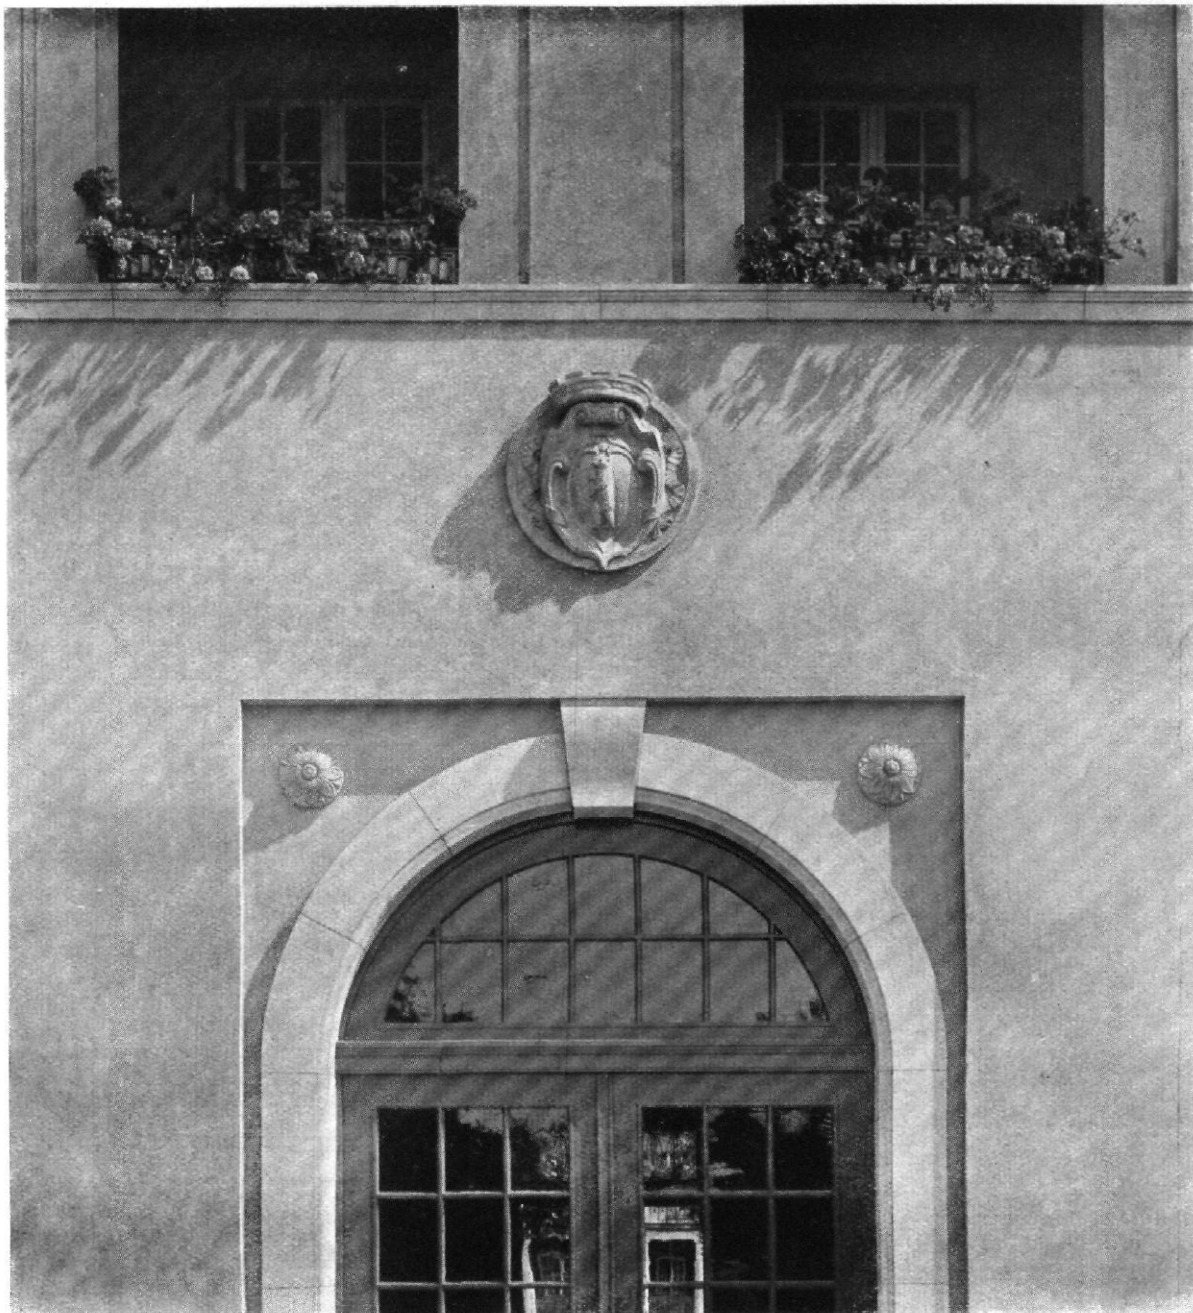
Verwaltungsgebäude. Rückfassade. Detail
